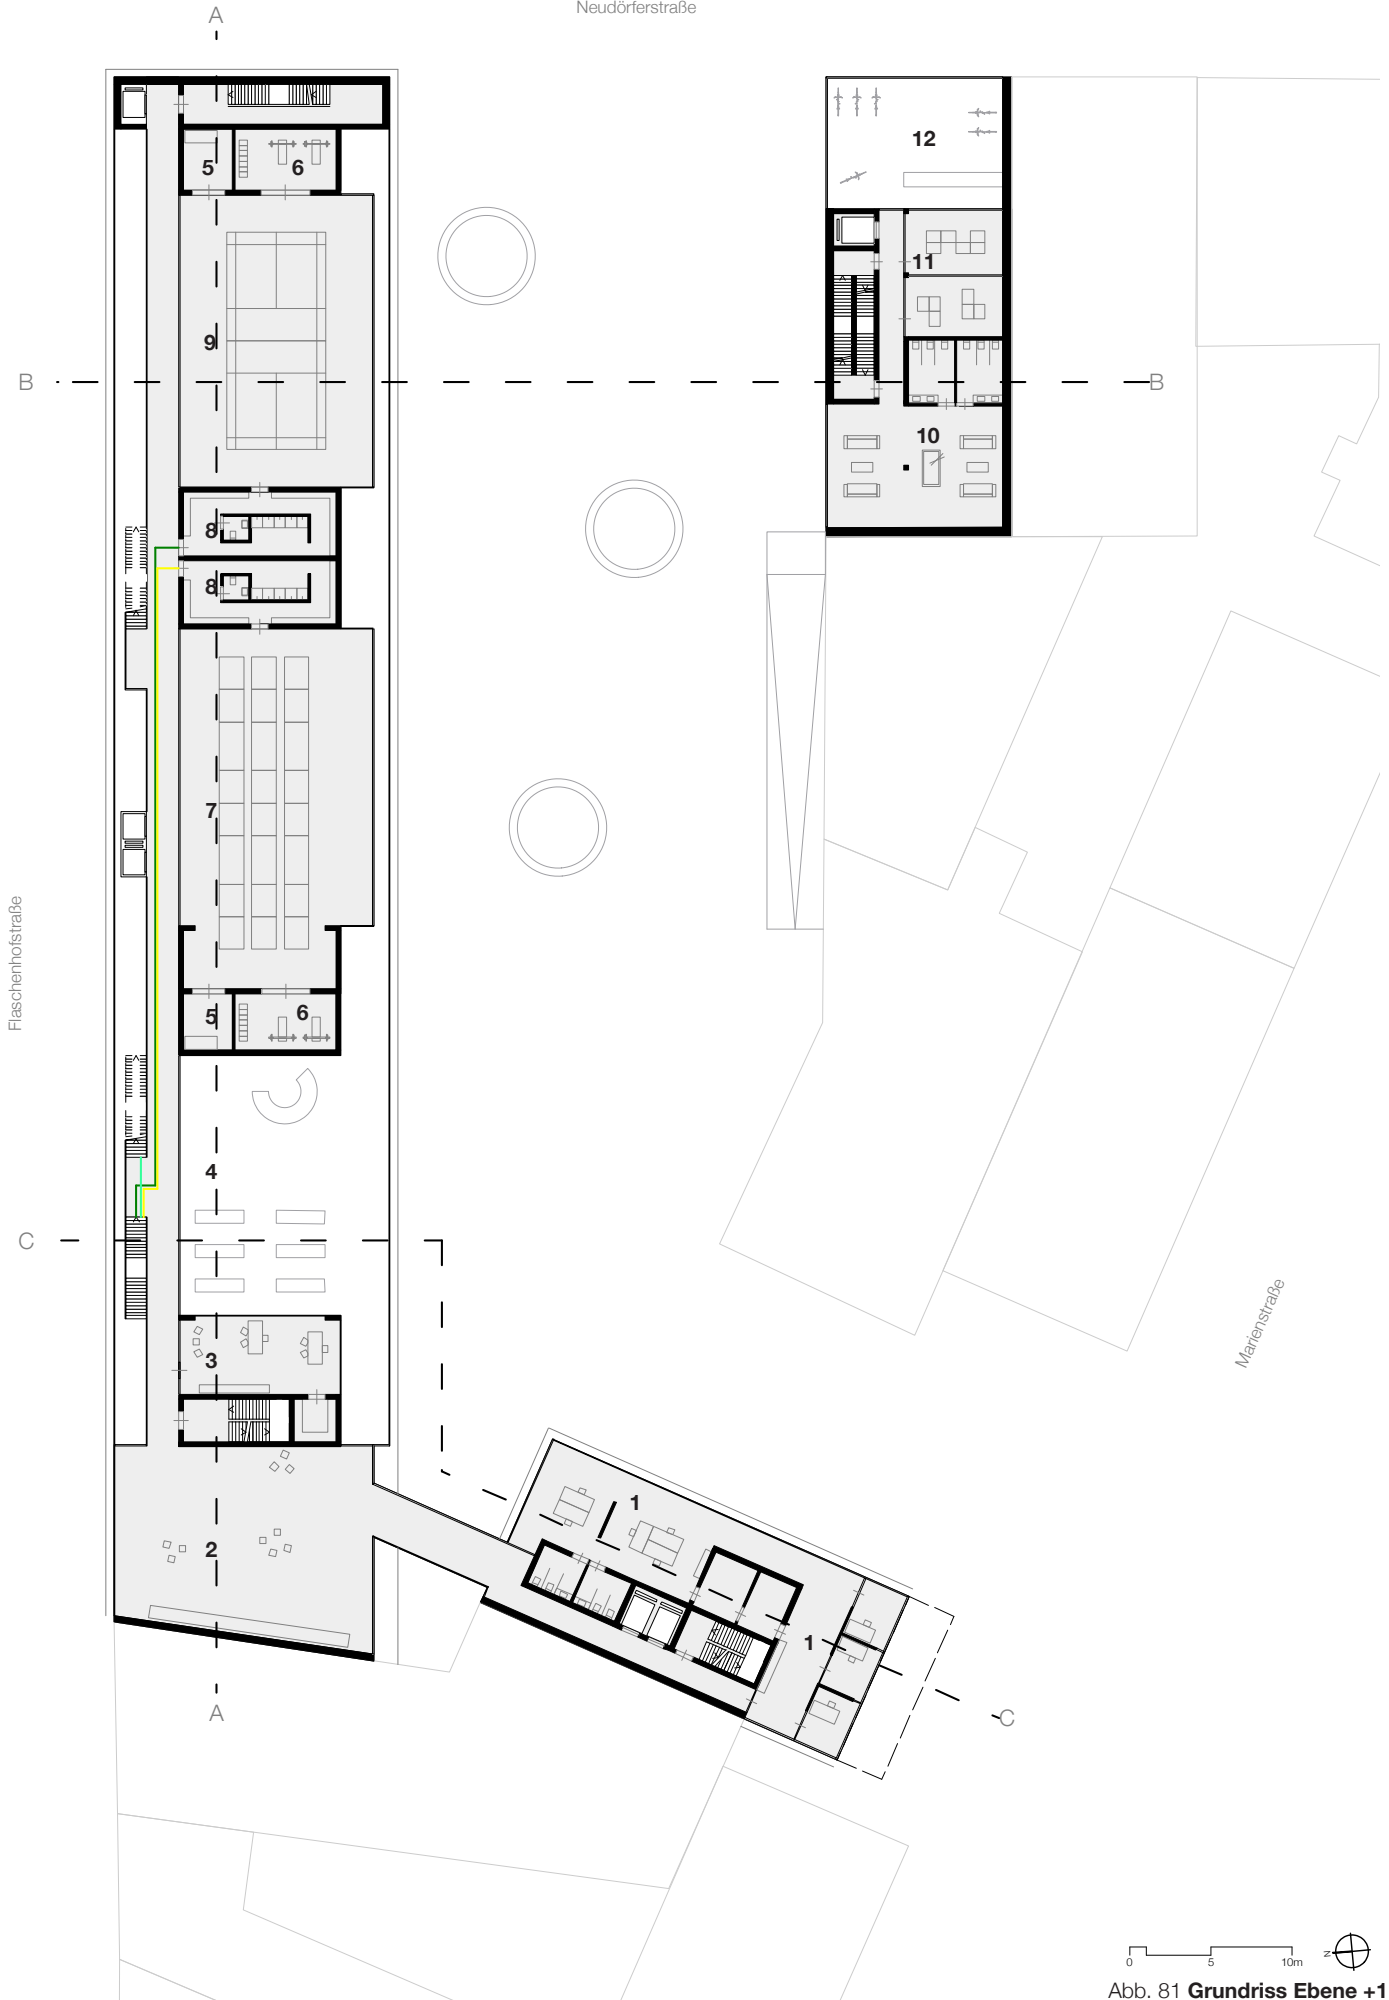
Grundriss Ebene +1 Entwurf 71
